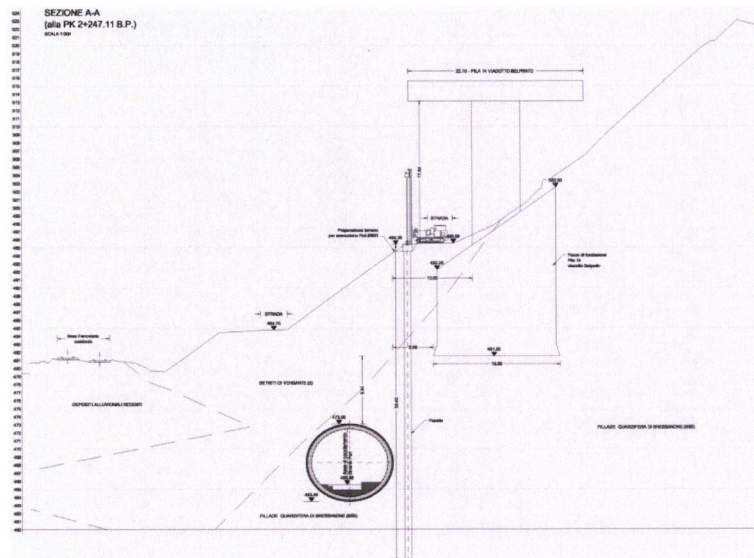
Sezione trasversale – Intervento con pali di cinturazione tra la galleria e la fondazione della pila 14
